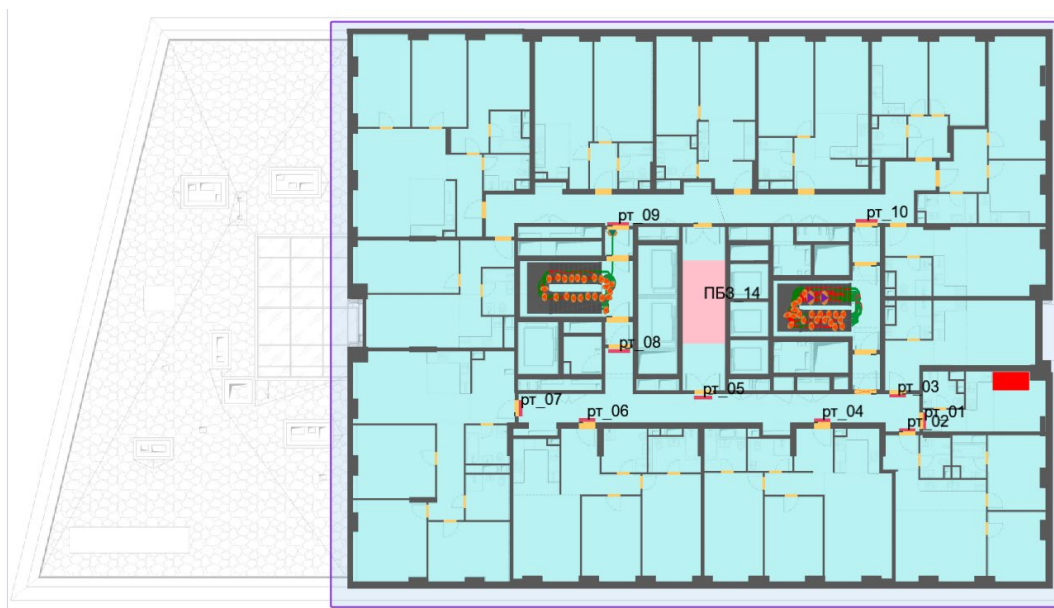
План 14-го этажа и нанесенная на него расчетная (принципиальная) схема эвакуации (расположение людей на момент полной эвакуации с этажа пожара – 2 мин. 27 сек.)
